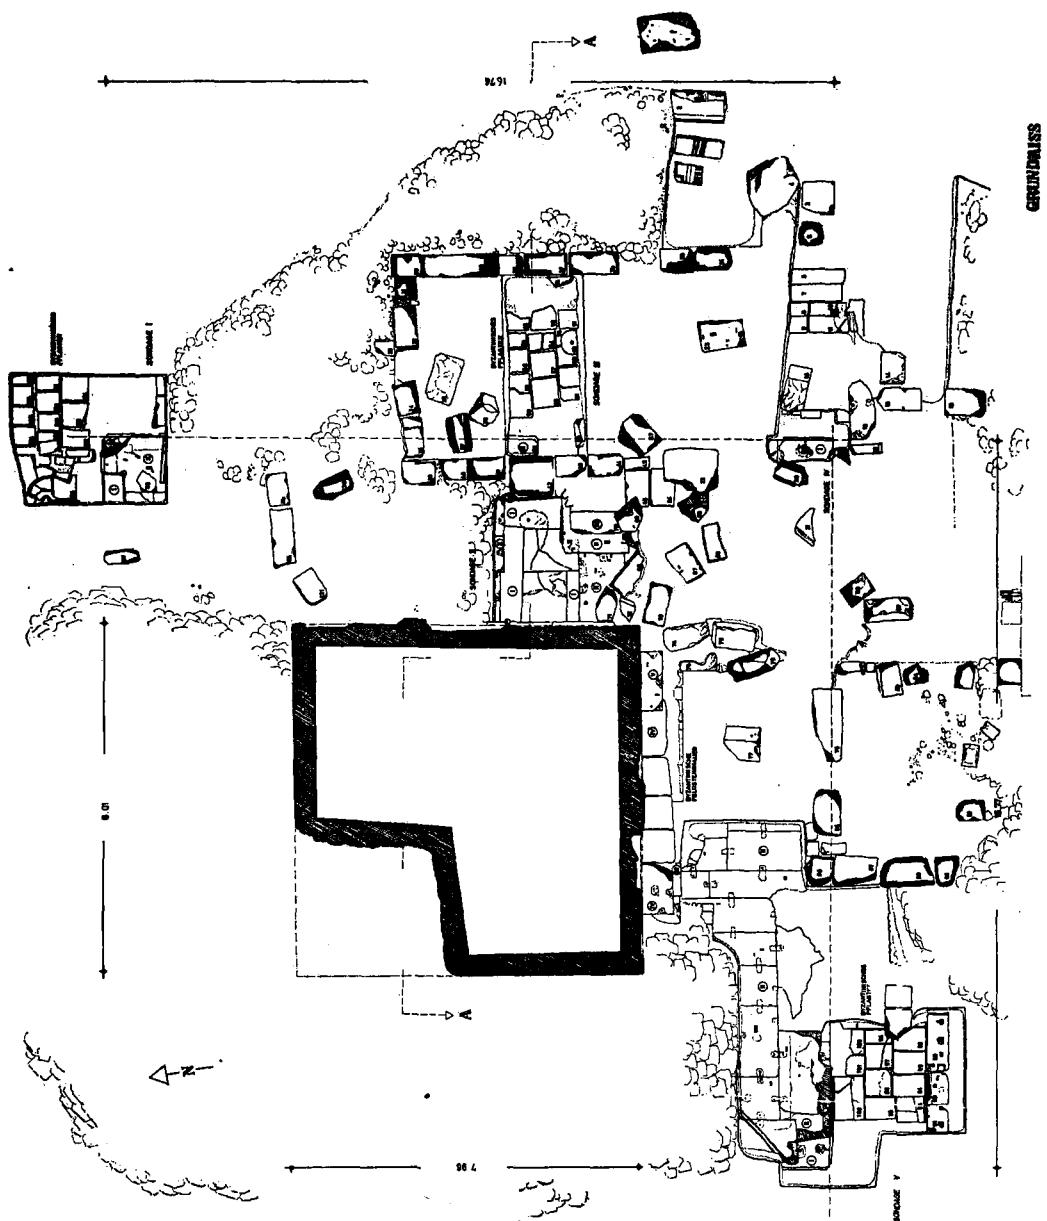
Grundriss des Kenotaph (K. Schulz)
